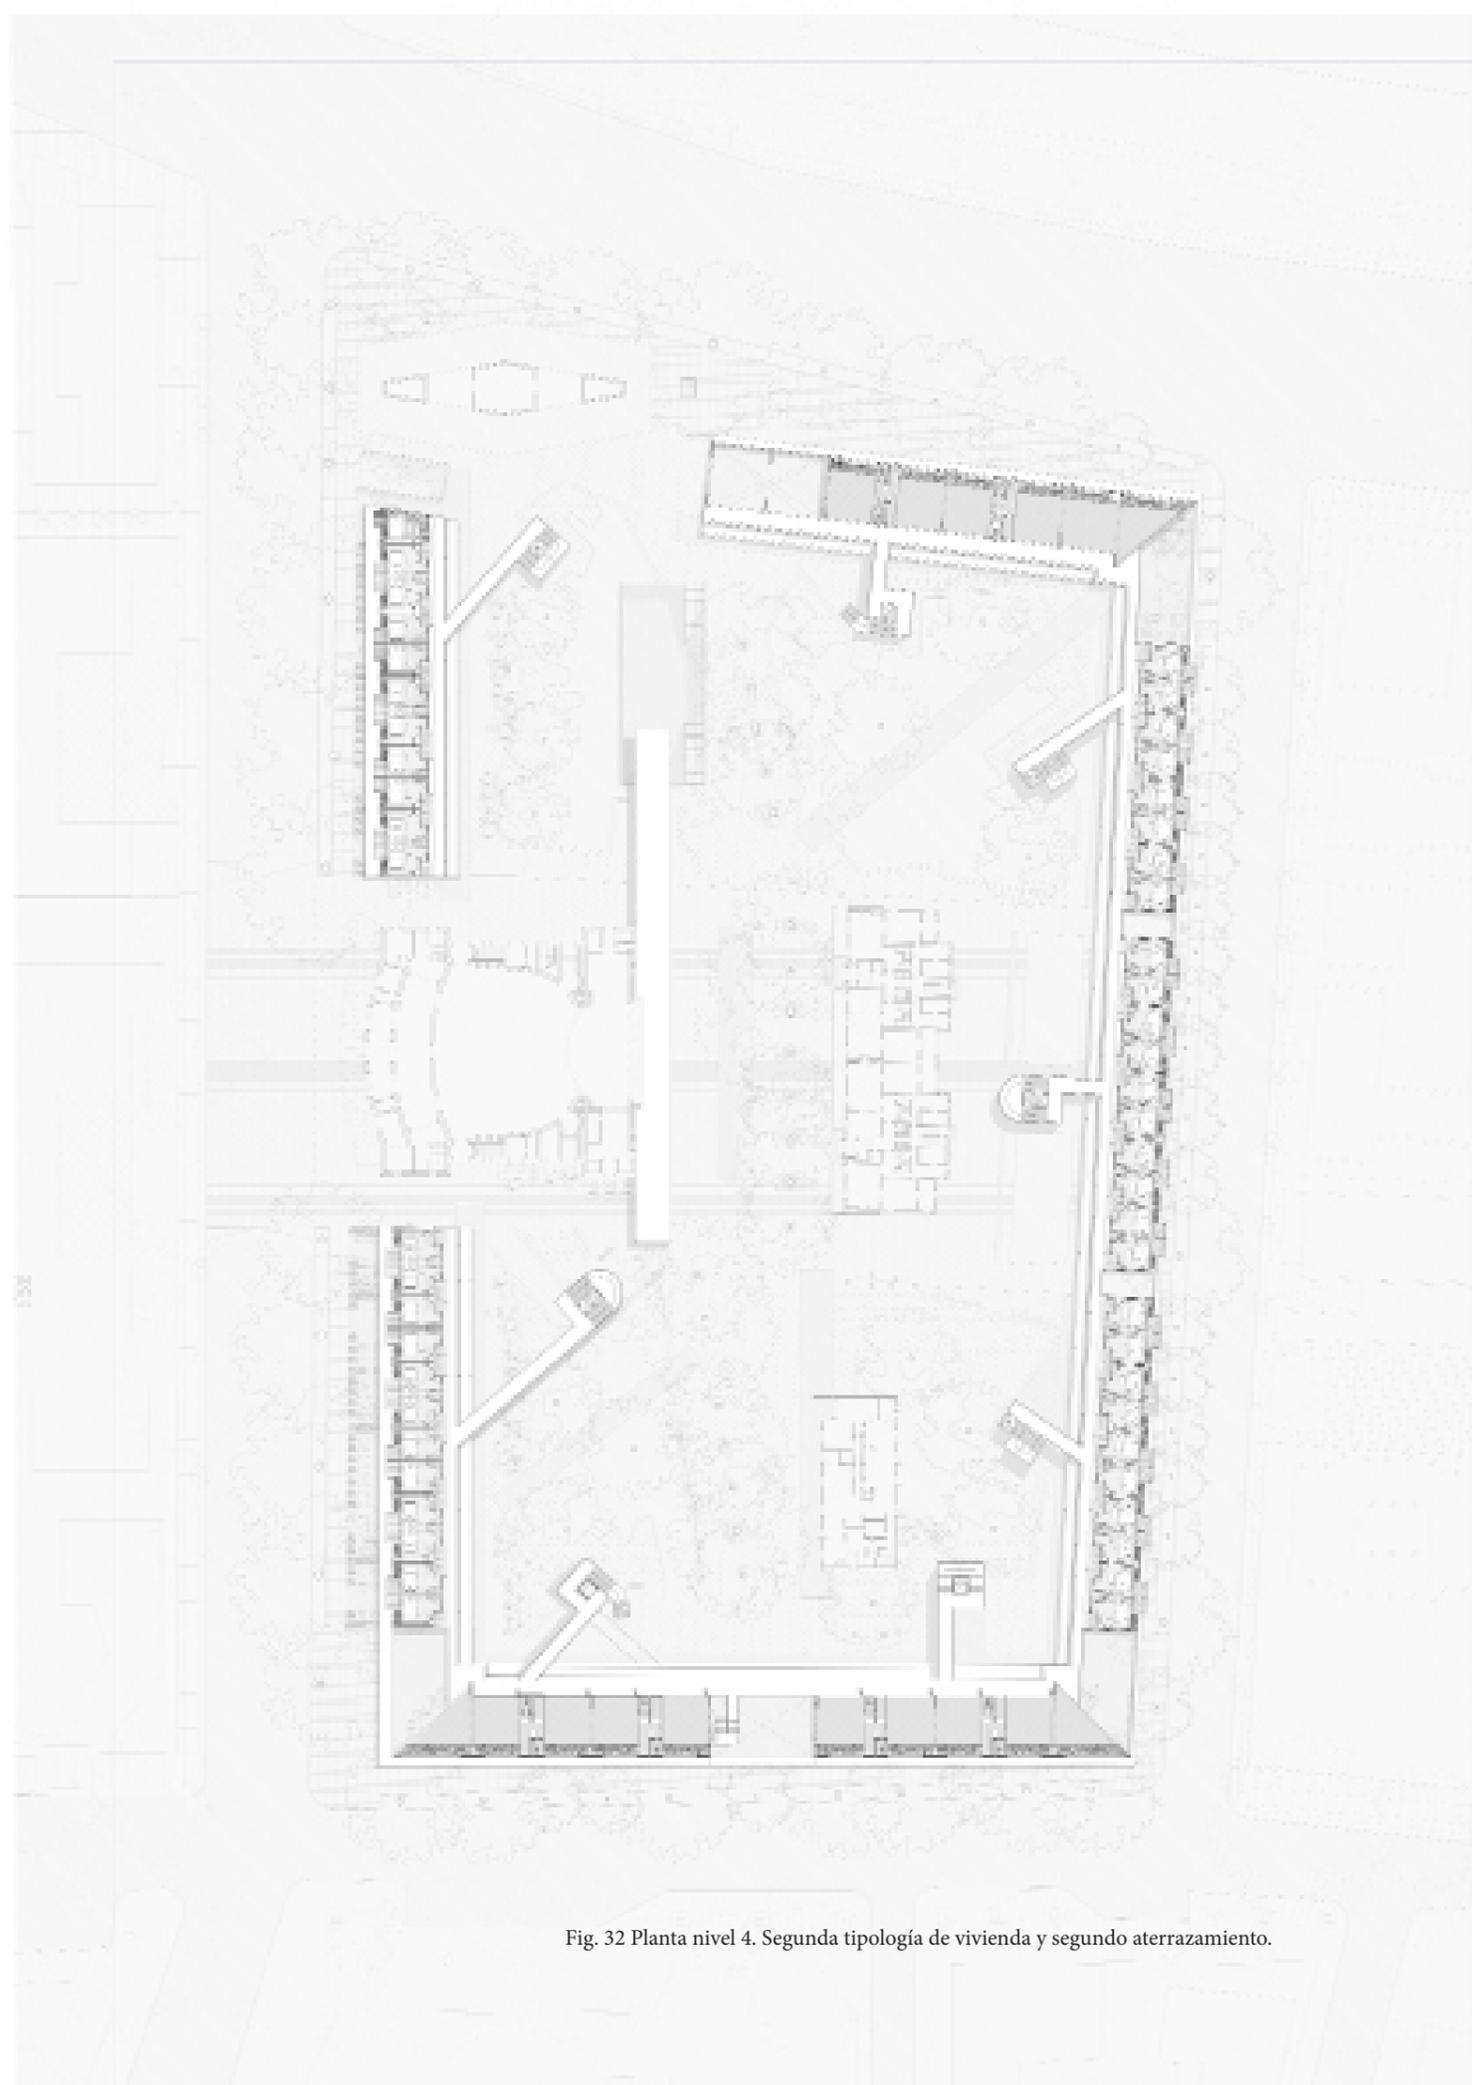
Planta nivel 4. Segunda tipología de vivienda y segundo aterrazamiento.
